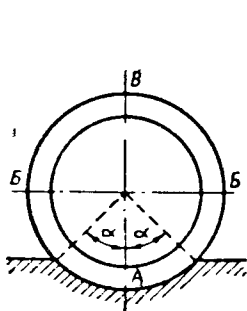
Опириание трубопровода на спрофилированное грунтовое ложе
